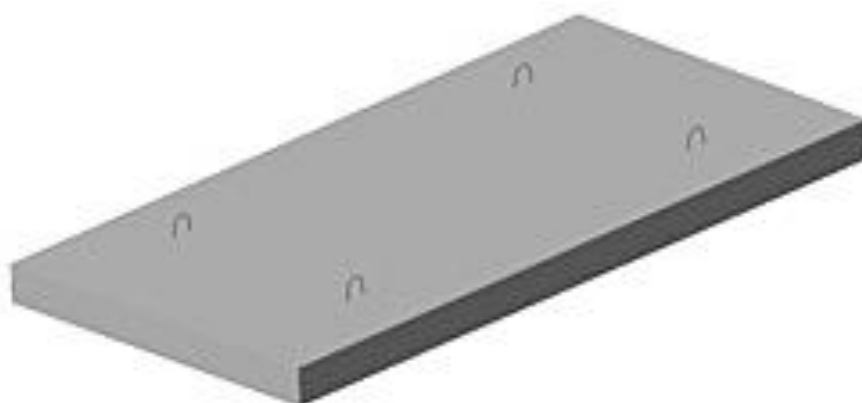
Сборная железобетонная плита сплошного сечения
